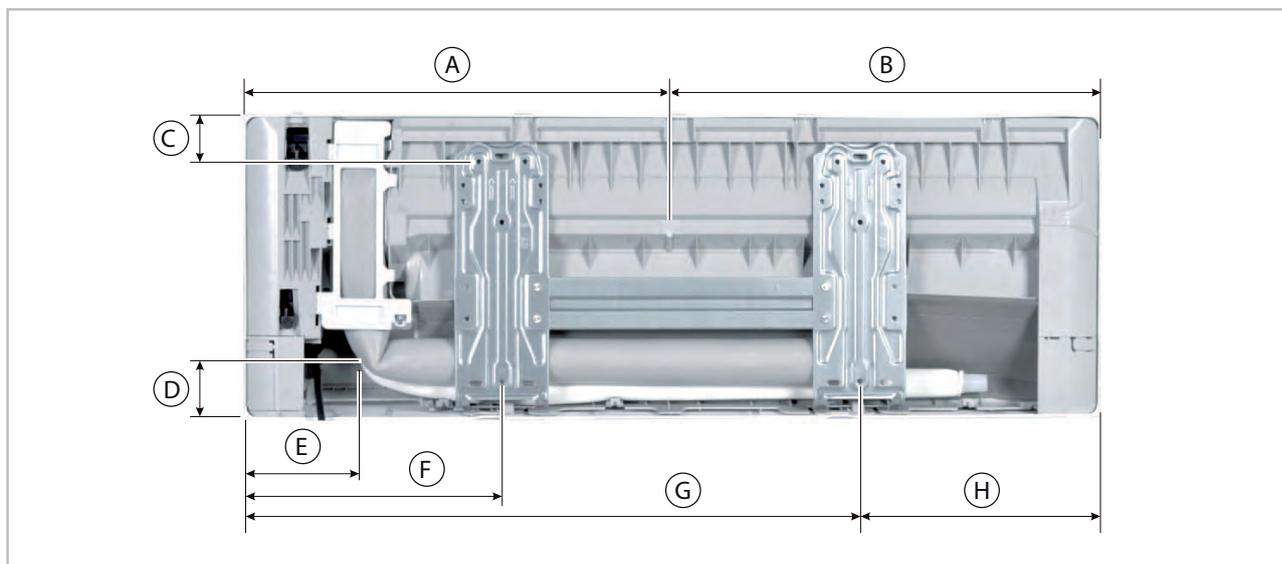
Points de montage du support mural BL 263-353 DC IT (vue arrière, toutes les dimensions sont en mm)
